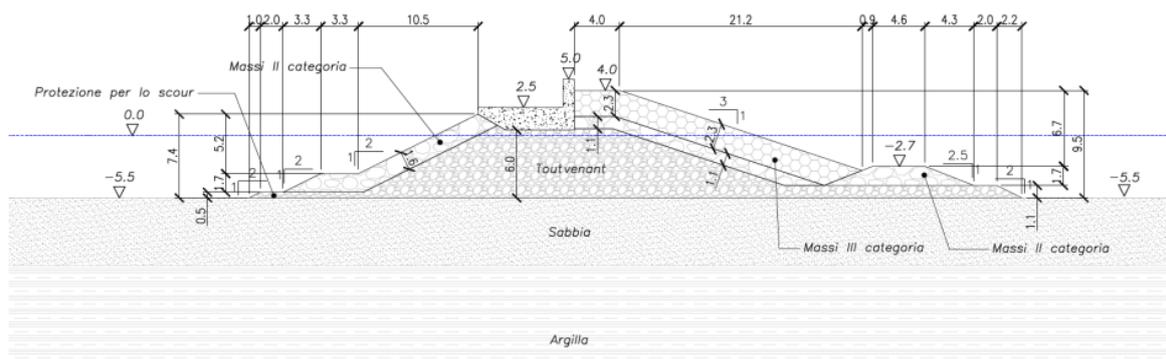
Sezione radice di collegamento a terra (Sez. O)
